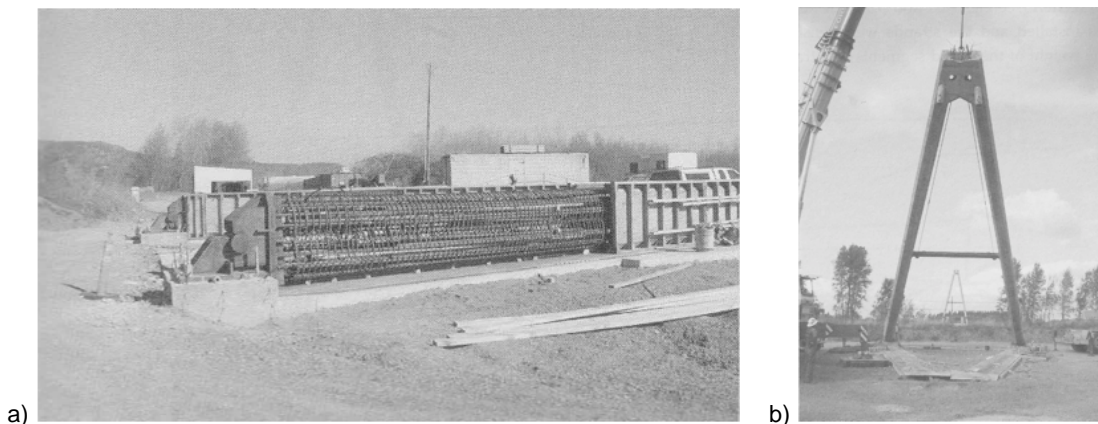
a) Betonagem do pilar *in situ* b) Erecção do pilar (Strasky (2005))
